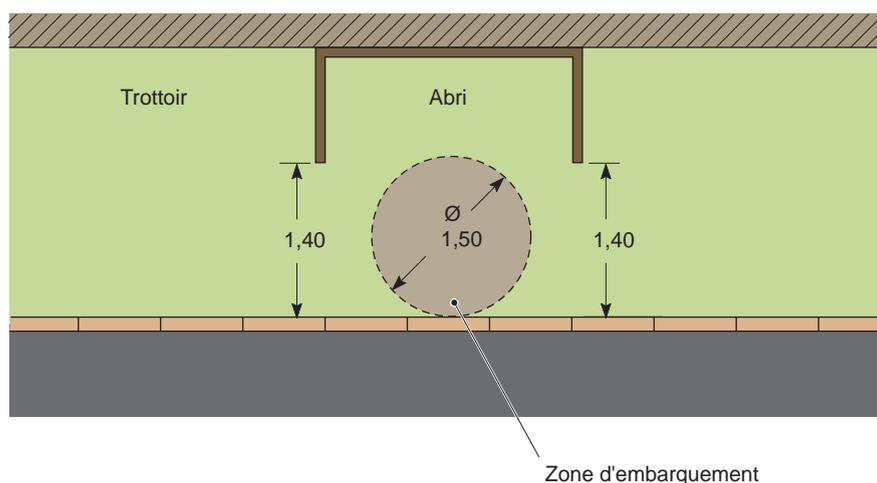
Implantation d'un arrêt de transport collectif sur un trottoir étroit.
